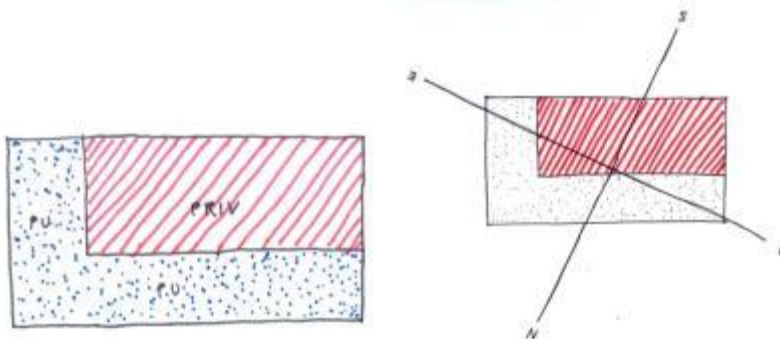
Planta Weekend House, Zona privada – pública y Orientación. Croquis realizado por el autor.
